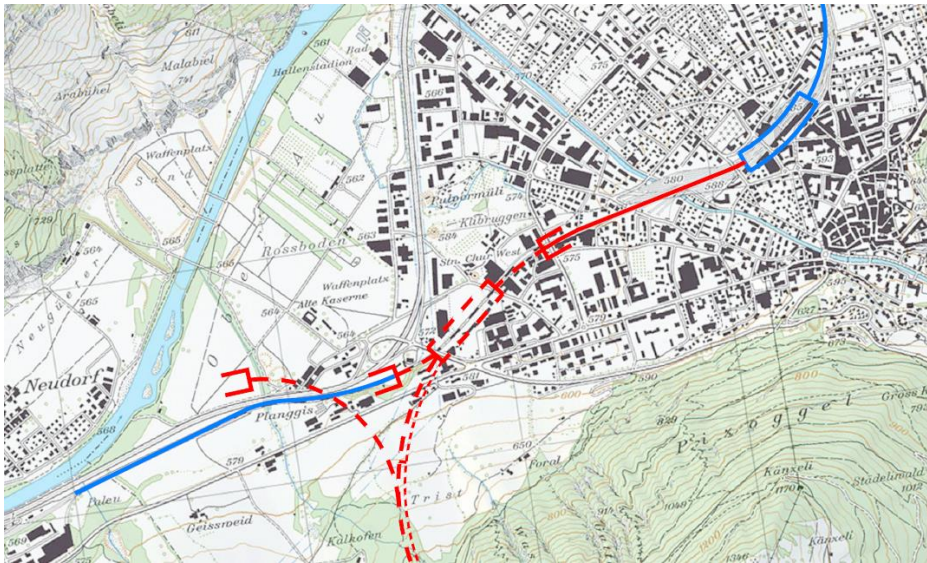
1: Ausschnitt Situationsplan, Anschluss / Bahnhof Chur West
